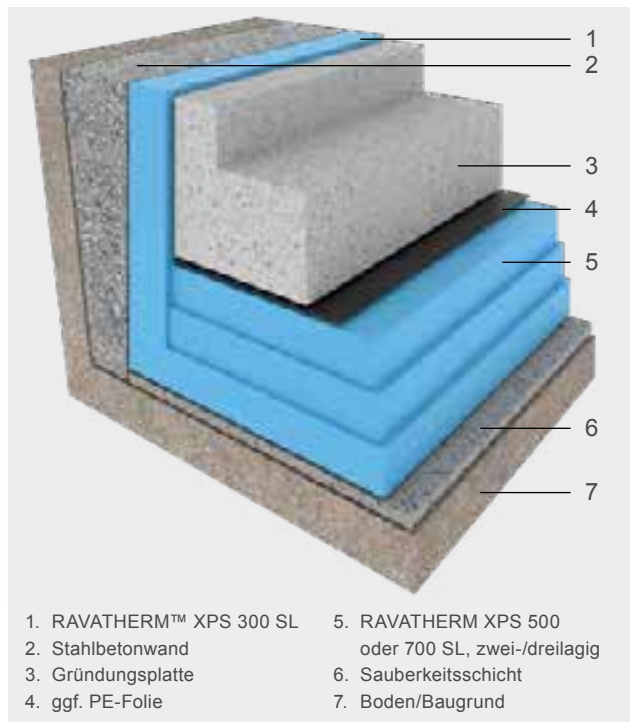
Detailbeispiel Fußpunkt „Weiße Wanne“: Wärmedämmung an Wand und unter lastabtragender Gründungsplatte in drückendem Wasser
